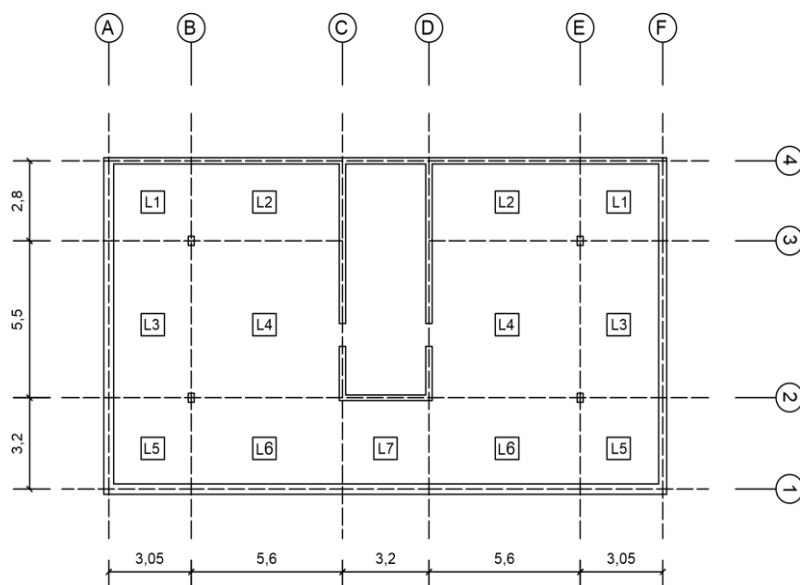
Planta de dimensionamento do caso de estudo 3
